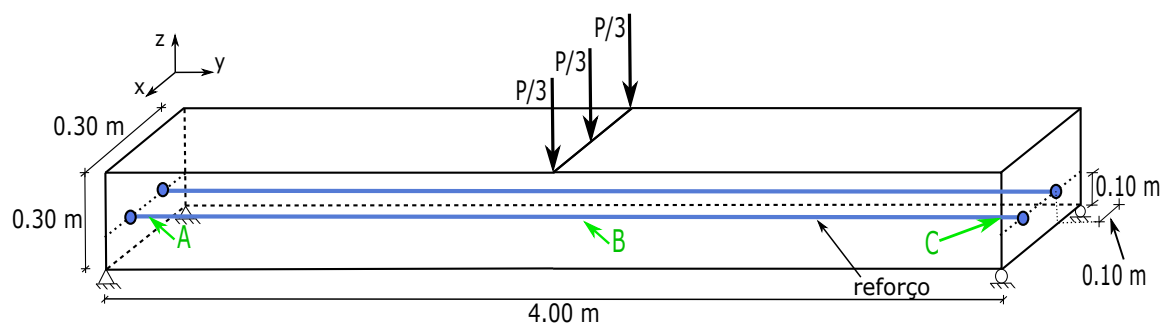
Viga proposta para análise do comportamento dinâmico da armadura.
